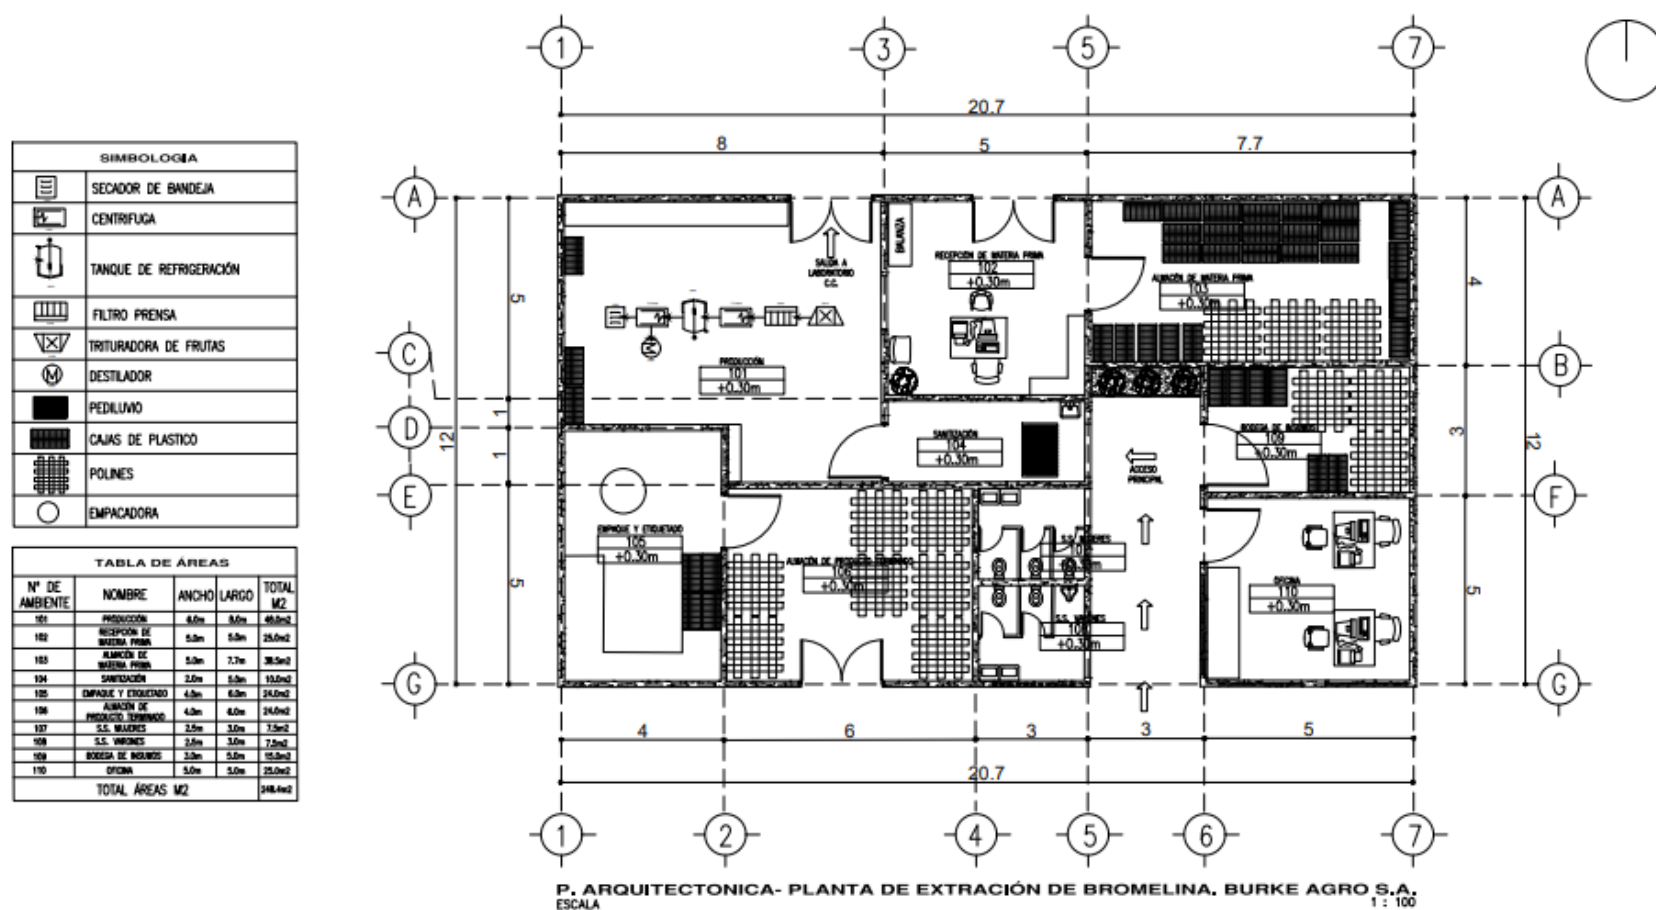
Plano general maestro. (Escala 1:100). Elaboración propia.
